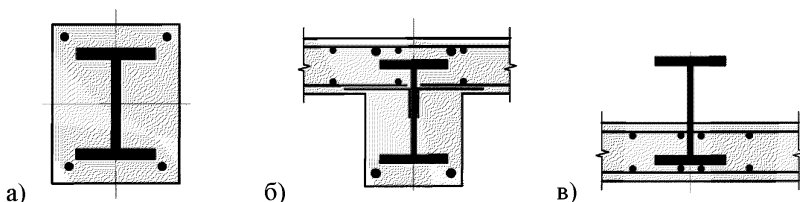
Типовые поперечные сечения комбинированных балок: а – полностью обетонированная балка прямоугольного сечения; б – полностью обетонированная балка таврового сечения; в – тавровая балка с опиранием железобетонной плиты на нижний пояс двутавровой балки
